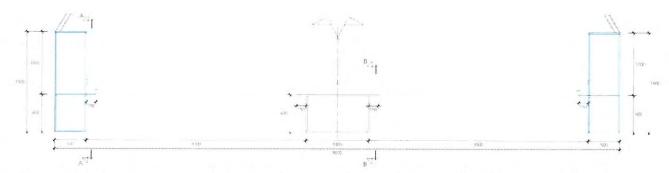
Corte transversal de la calzada. Se observan los cajones laterales y central formado por placas de acero A50.
